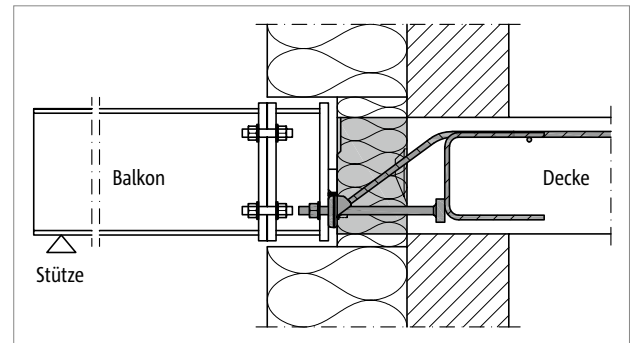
Schöck Isokorb® XT Typ SQP: Anschluss des Stahlträgers an einen Adapter, der die Dicke der Außendämmung ausgleicht
